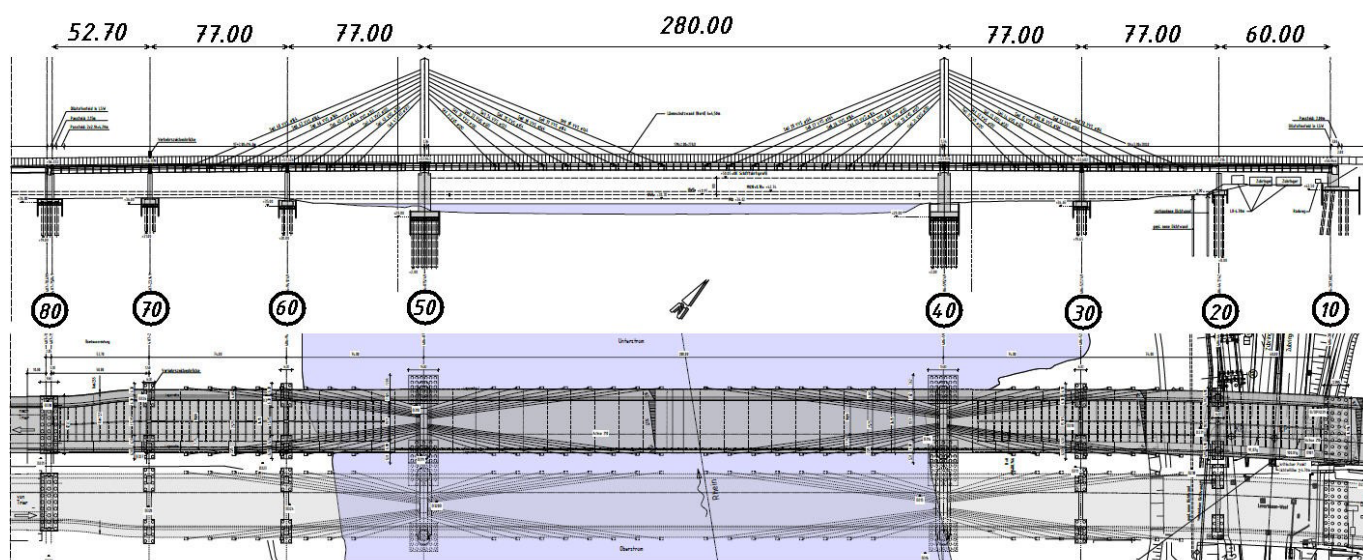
Alzado y planta del nuevo puente sobre el Rin en Leverkusen (LAP).
